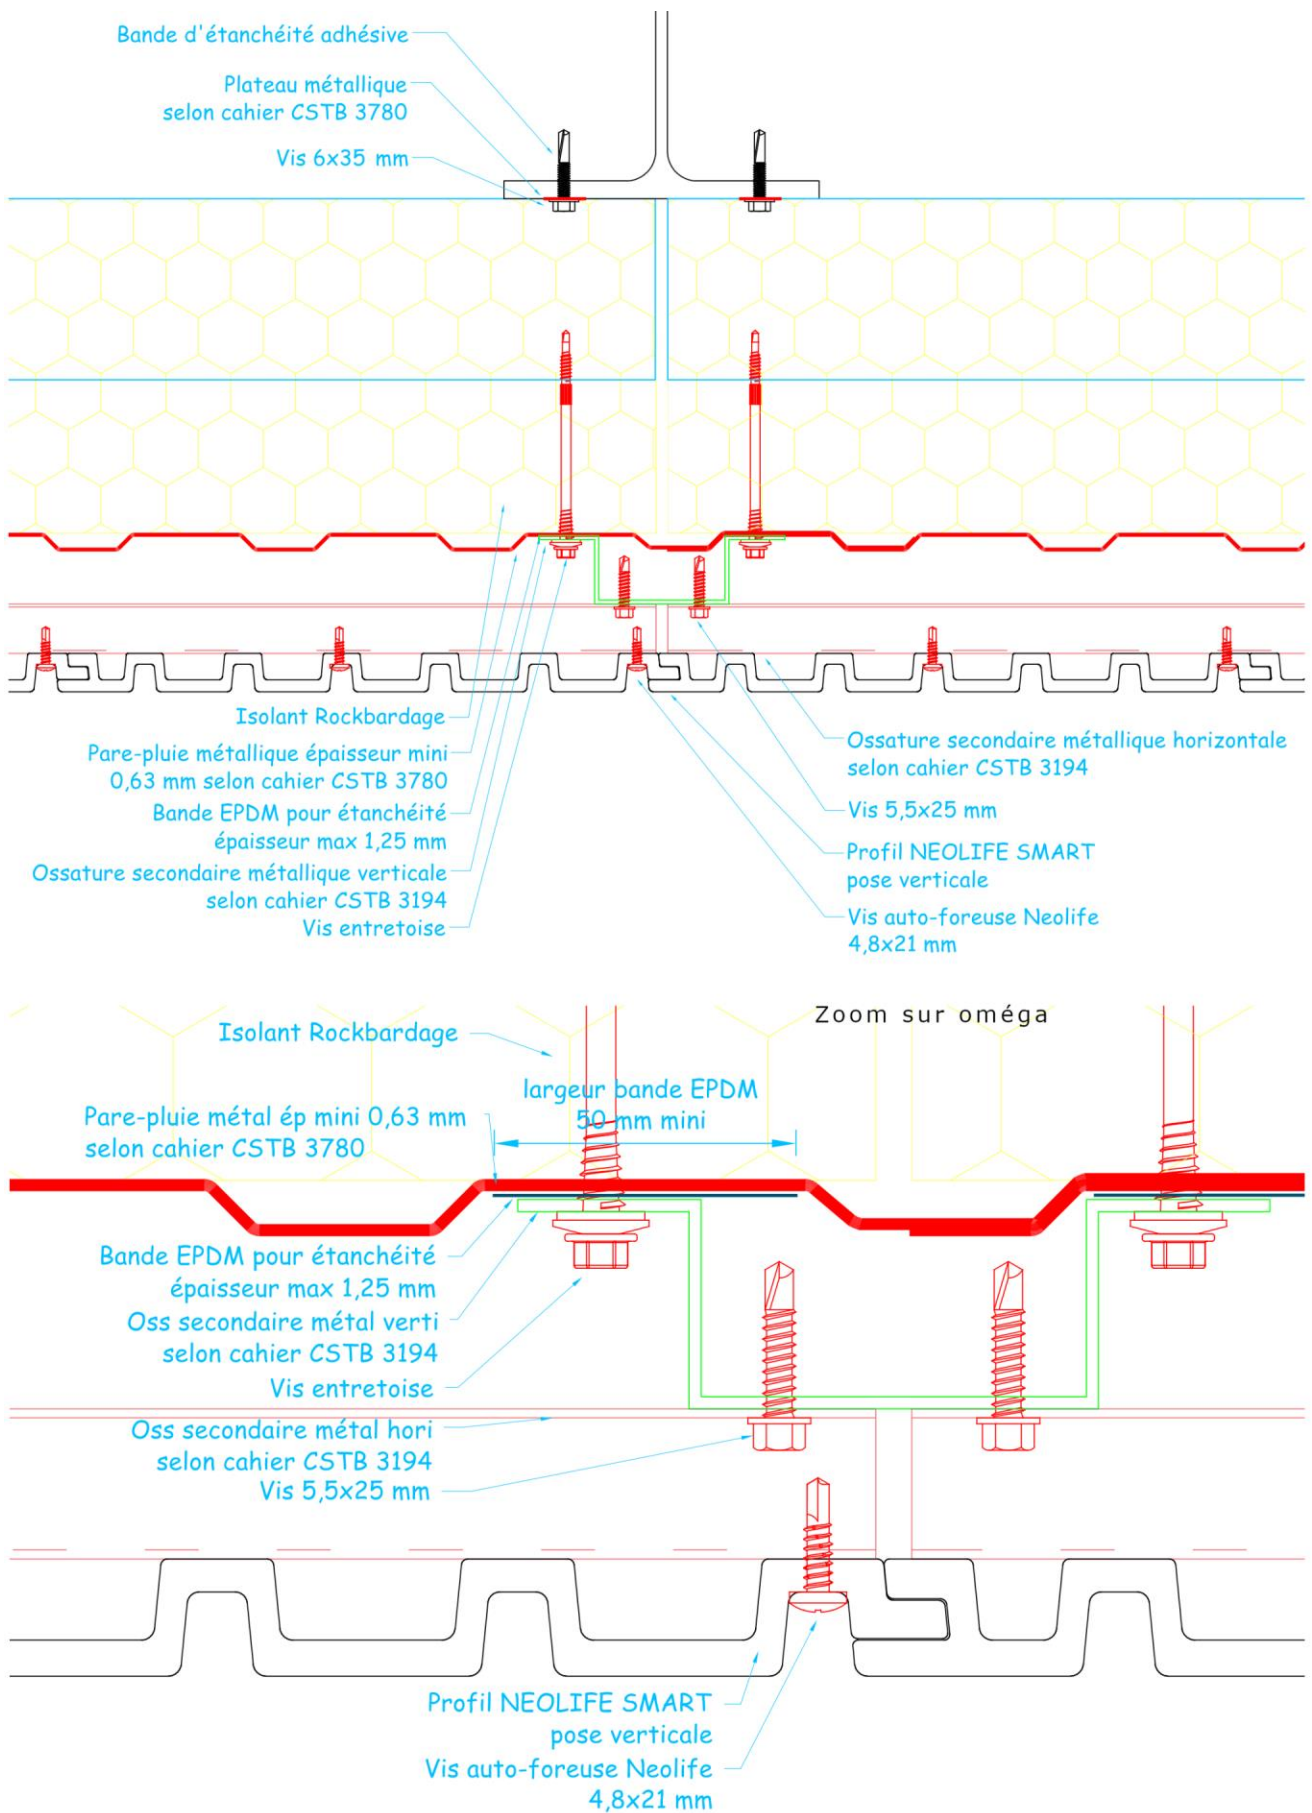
Jonction entre lames, sans fractionnement de la lame d'air (coupe horizontale)
